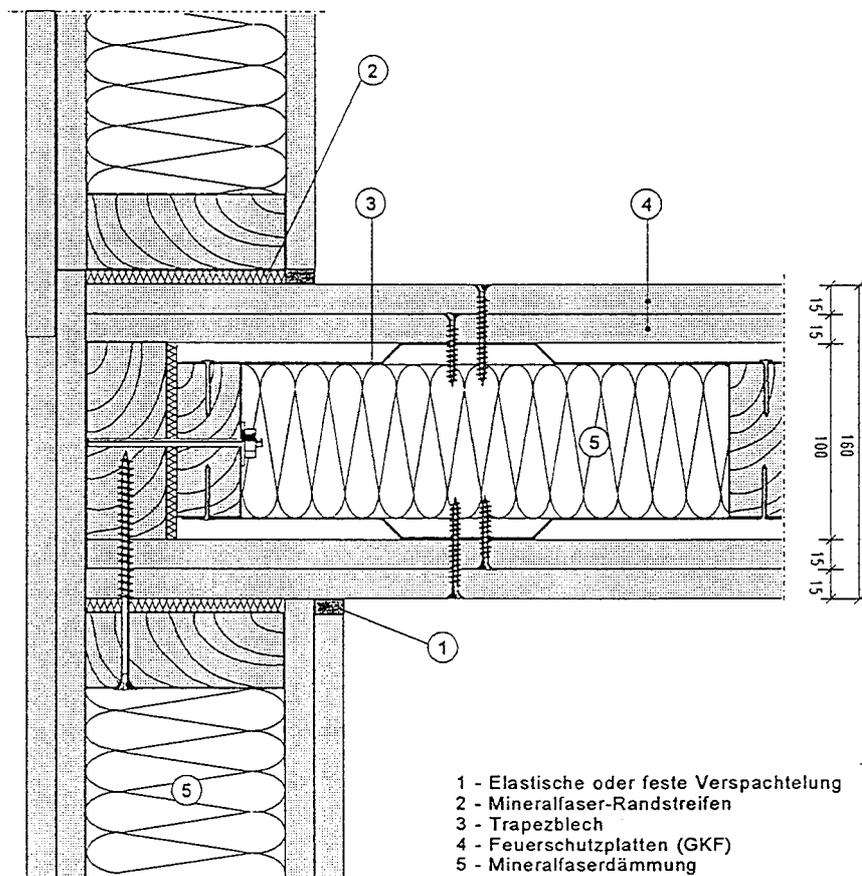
Variante 2 einer "Brandwand" in Trockenbauweise mit Holzunterkonstruktion. Aussteifung über den F90-BA Gebäudeabschnitt.
